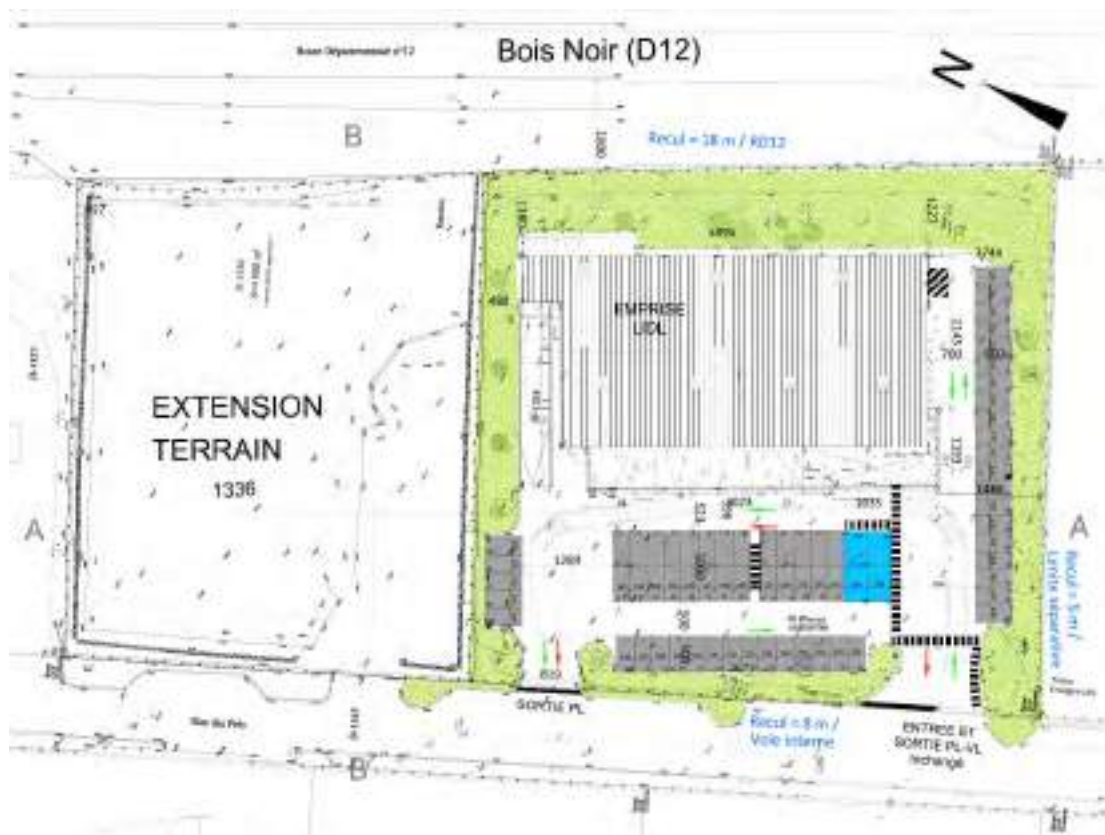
Extrait du plan de masse de l'existant et parcelle pour extension de parking
